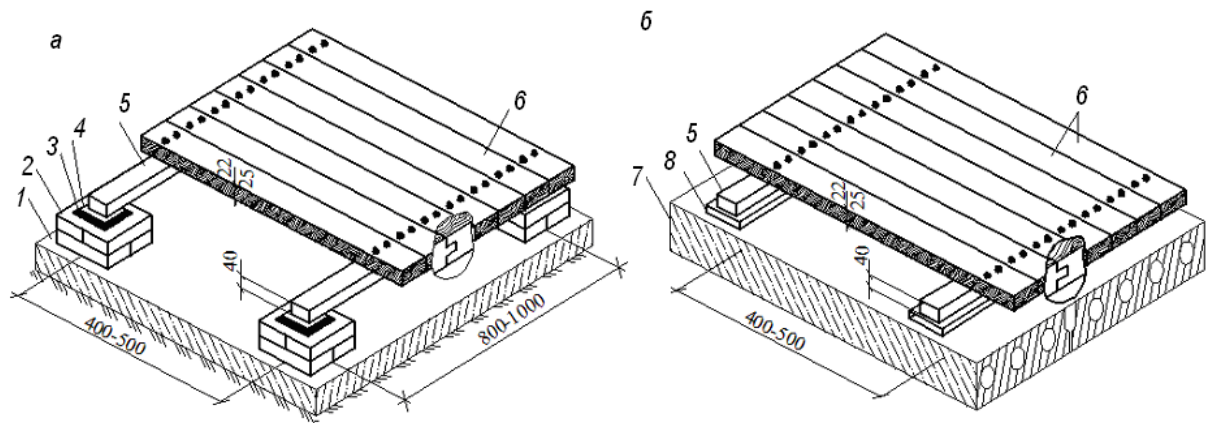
Дощані підлоги по ґрунту (а) і по перекриттю (б): 1 –бетонна підготовка; 2 – цегляний стовпчик; 3 – гідроізоляційна прокладка; 4 – підкладка для вирівнювання; 5 – лага; 6 – шпунтовані дошки; 7 – міжповерхове перекриття; 8 – звукоізоляційна прокладка
